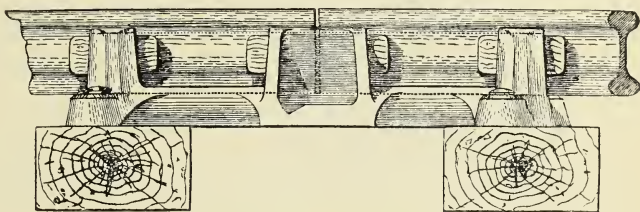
Älteste Form der Stoßbrücke, 1849.
